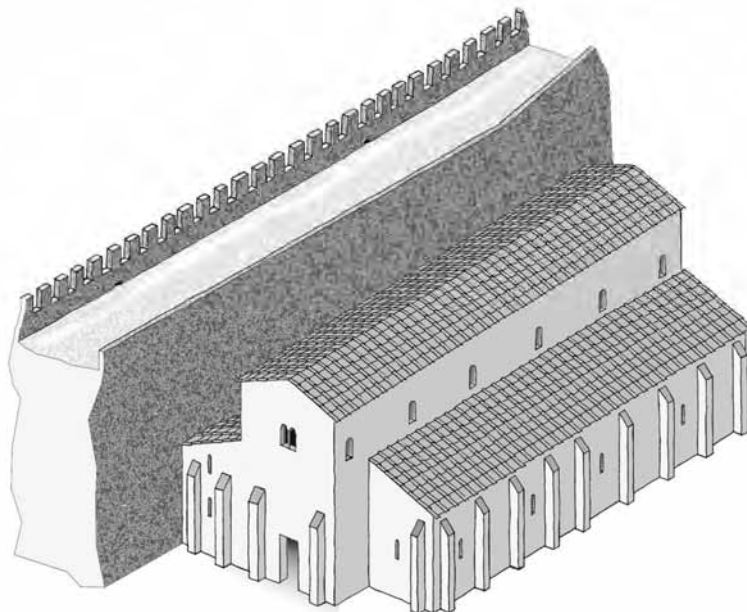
Levantamiento del edificio anterior realizado en base a los restos excavados.
